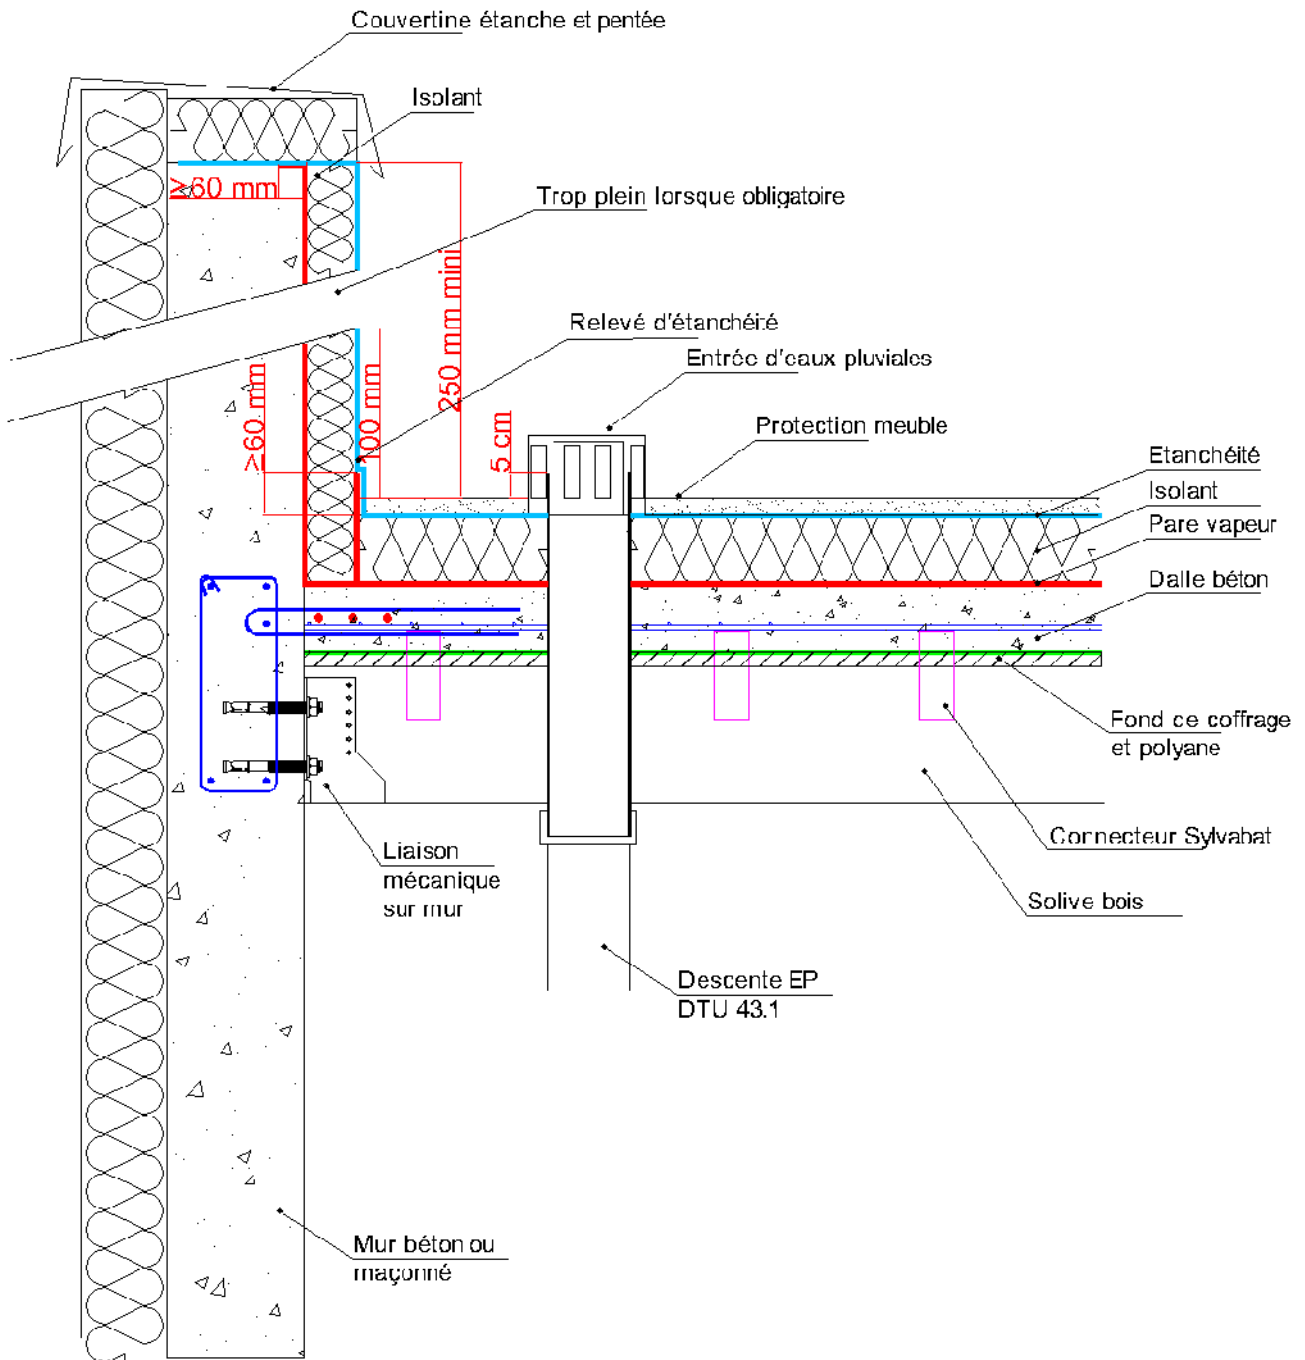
Détail type pour toiture terrasse inaccessible protection lourde meuble relief béton
